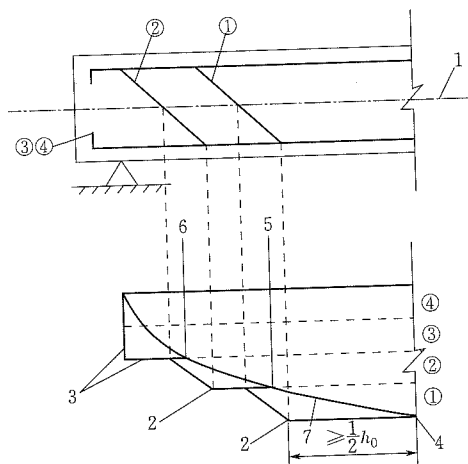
弯起钢筋弯起点位置示意图(一)
